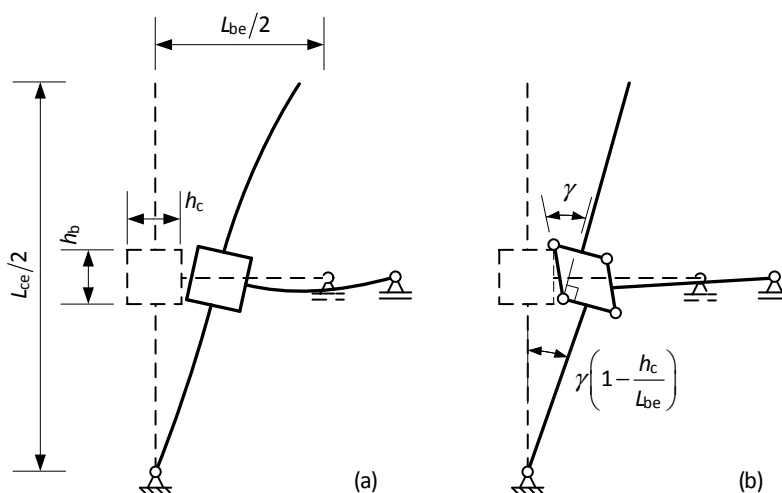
Componentes da deformabilidade da subestrutura representada na Figura 3.17, (a) flexão da viga e dos pilares, (b) distorção da ligação viga-pilar.
